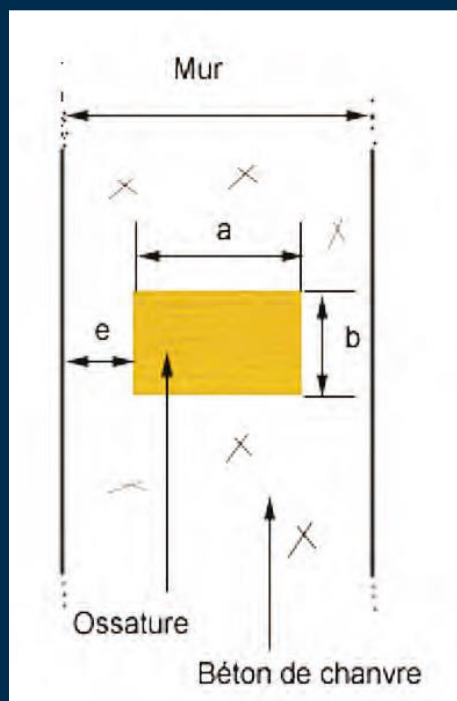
Coupe horizontale du mur ; épaisseur d'enrobage (e) et section de bois (a et b)
